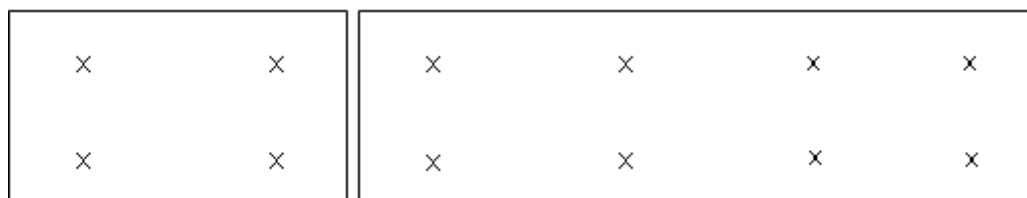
Plaatsing bevestigingen voor mechanisch bevestigde platen
